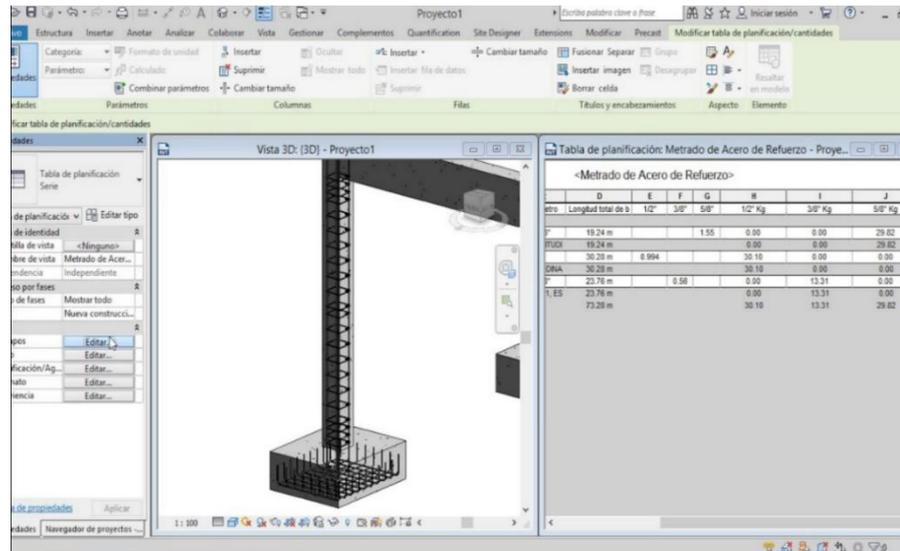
Vista de cálculo de metrado de zapata centrada en software Revit
